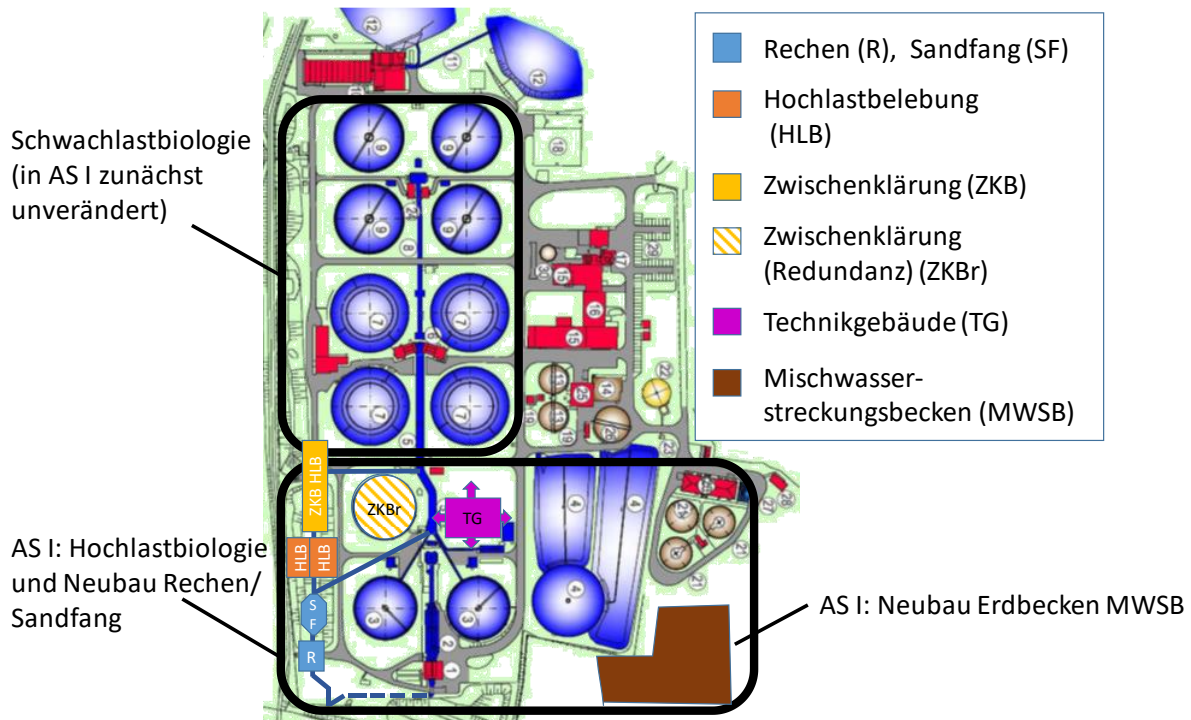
Lageplan der Kläranlage Düren nach Bau der Ausbaustufe I
